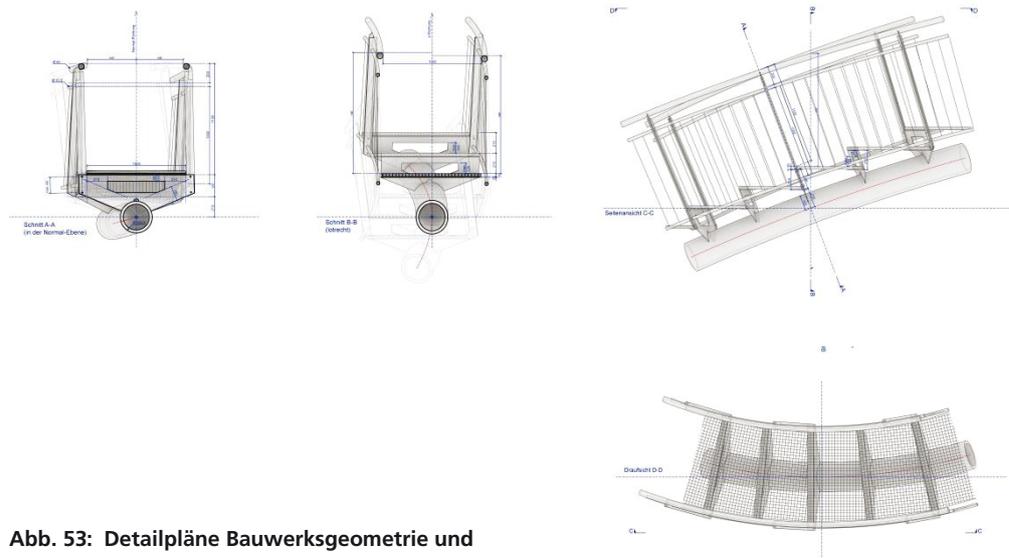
Detailpläne Bauwerksgeometrie und Konstruktion
